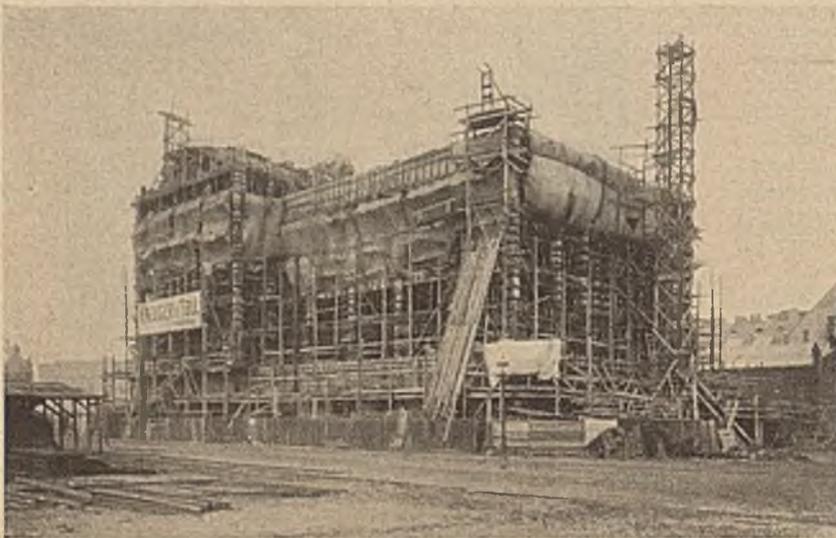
Magazingebäude des Helsingfors Magazins A.B.
